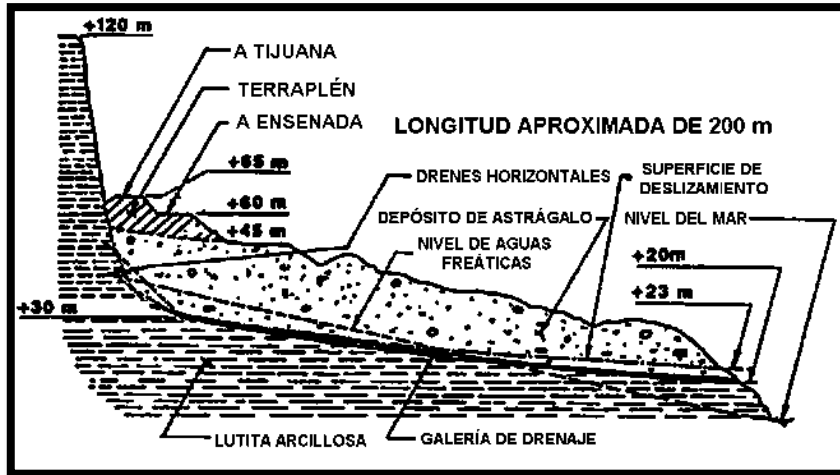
Sección transversal de la galería de drenaje en la carretera Tijuana-Ensenada (Rodríguez et al., 1988).
